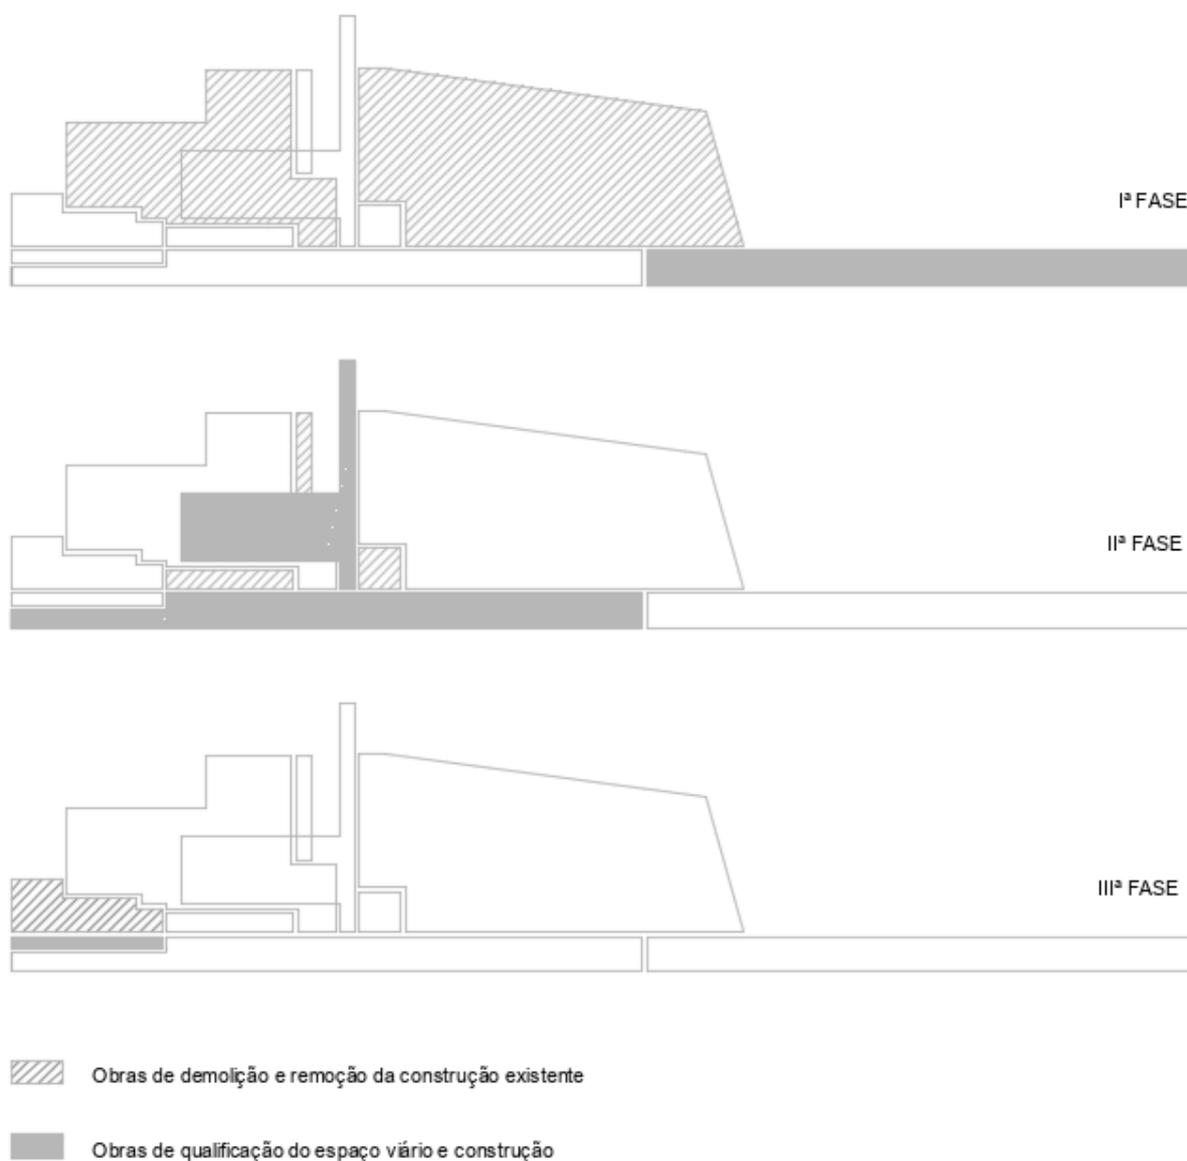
Esquema indicativo do faseamento e articulação das obras de demolição e construção em Cedovém
